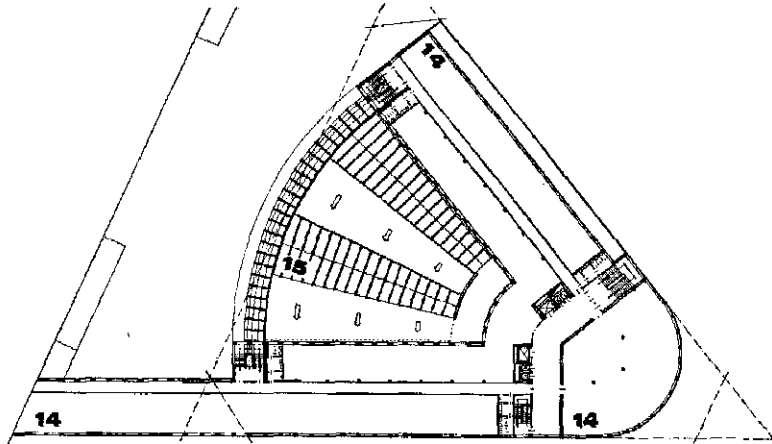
/ Hochhaus-Wettbewerb Bahnhof Friedrichstraße / Architekt: Erich Mendelsohn, Berlin
